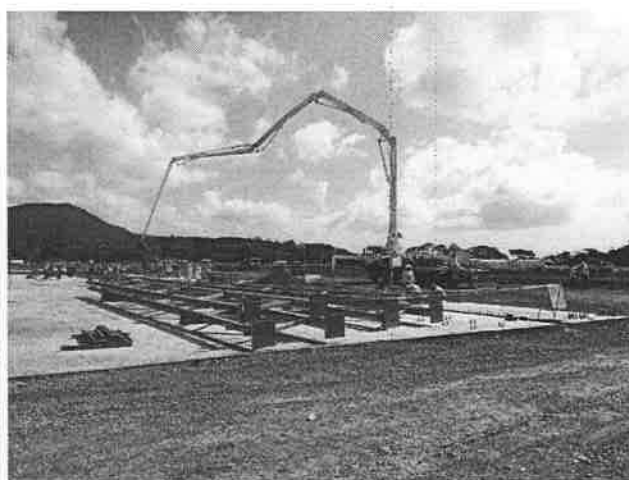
vaciado de cemento, por concretas, para la construcción de fundaciones y bases de estructuras físicas en el proyecto.
